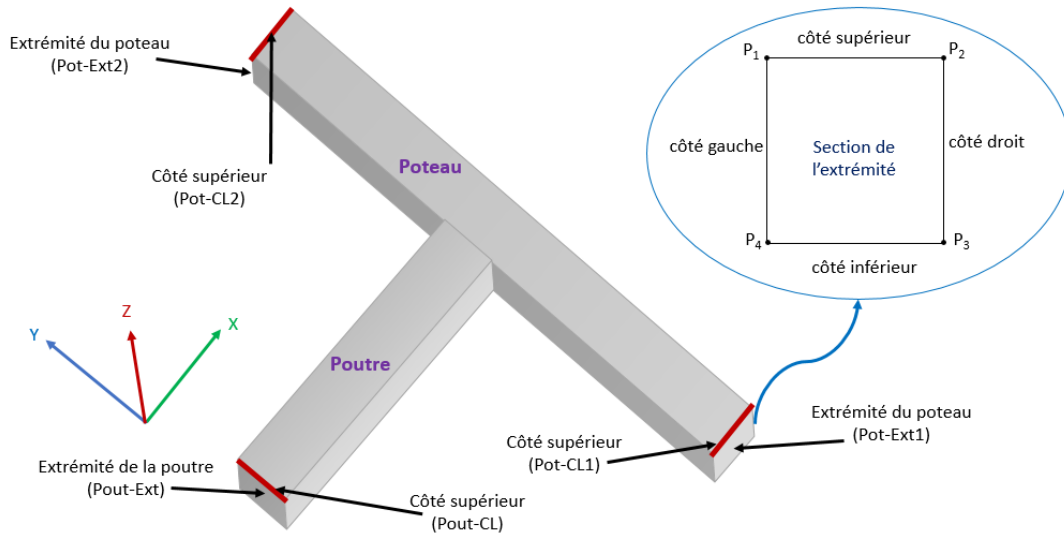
Extrémités de l'assemblage poutre-poteau : notations et direction du champ de déplacement
